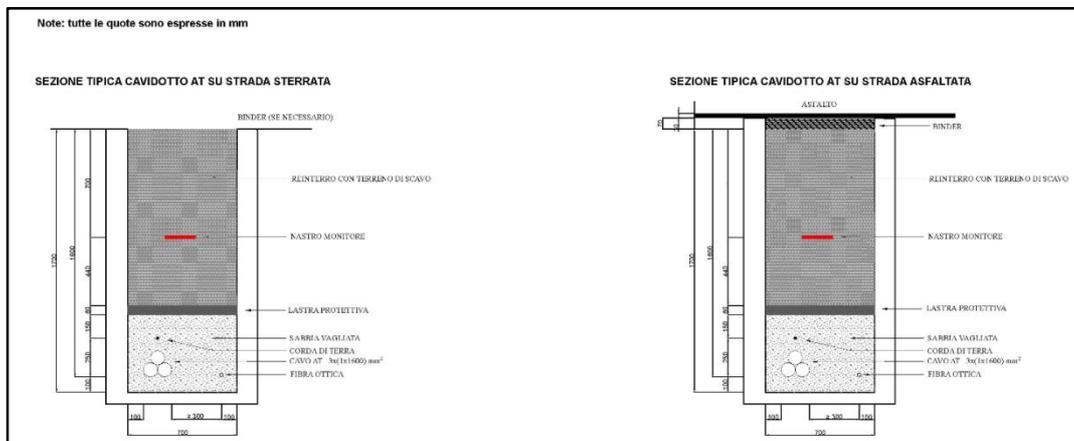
Sezione tipica del cavidotto AT di connessione tra la stazione di condivisione e il nuovo stallo della stazione elettrica di trasformazione 380/150 kV denominata "Aliano"
